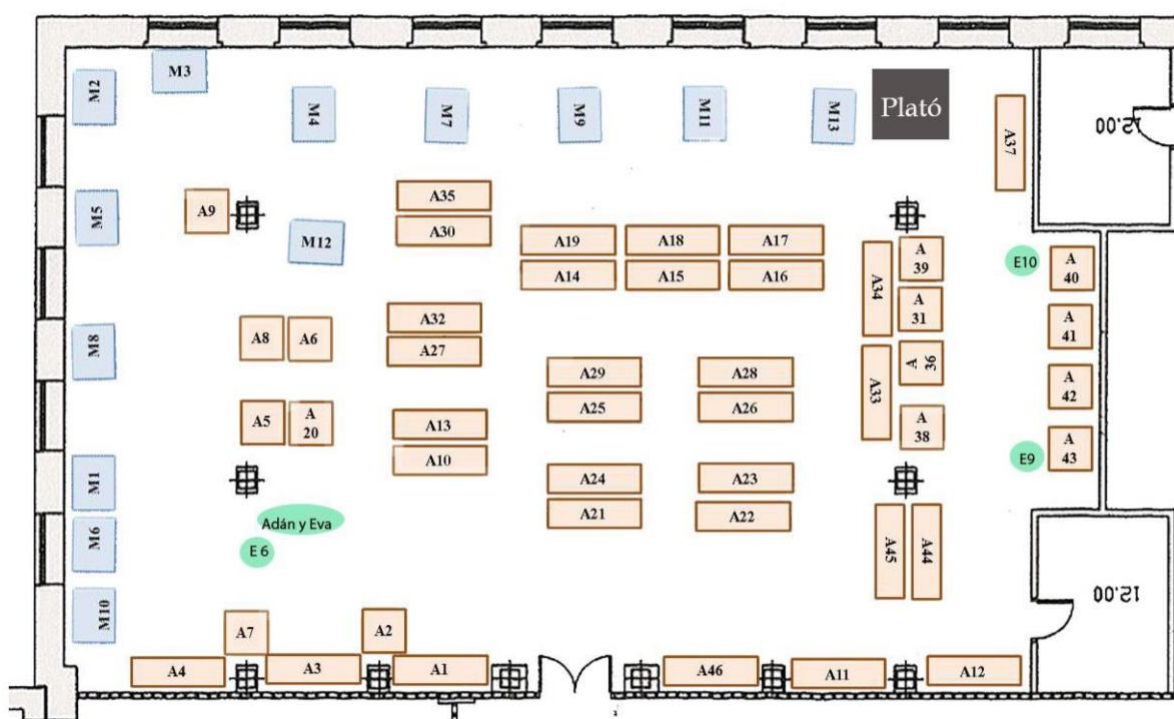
Rivera D. (2013). Plano del Museo "Javier Puerta" donde estaba ubicado el plató
